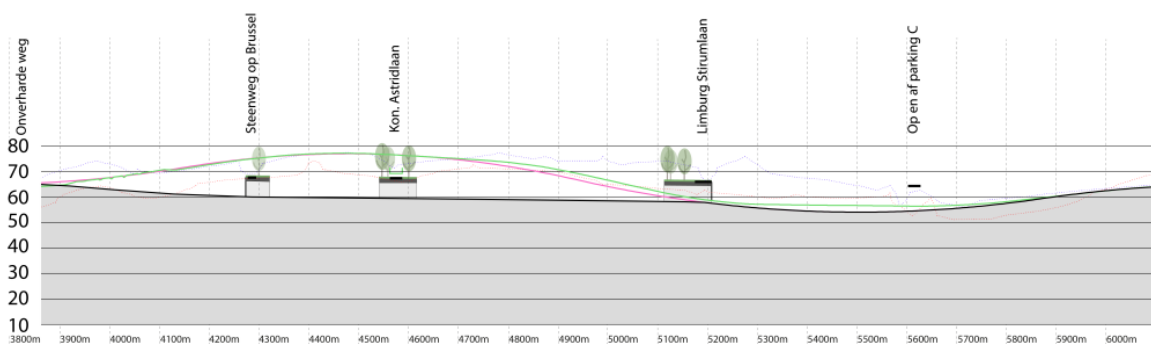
Profil longitudinal de la variante de recherche alternative minimale « light » avec trois ponts
